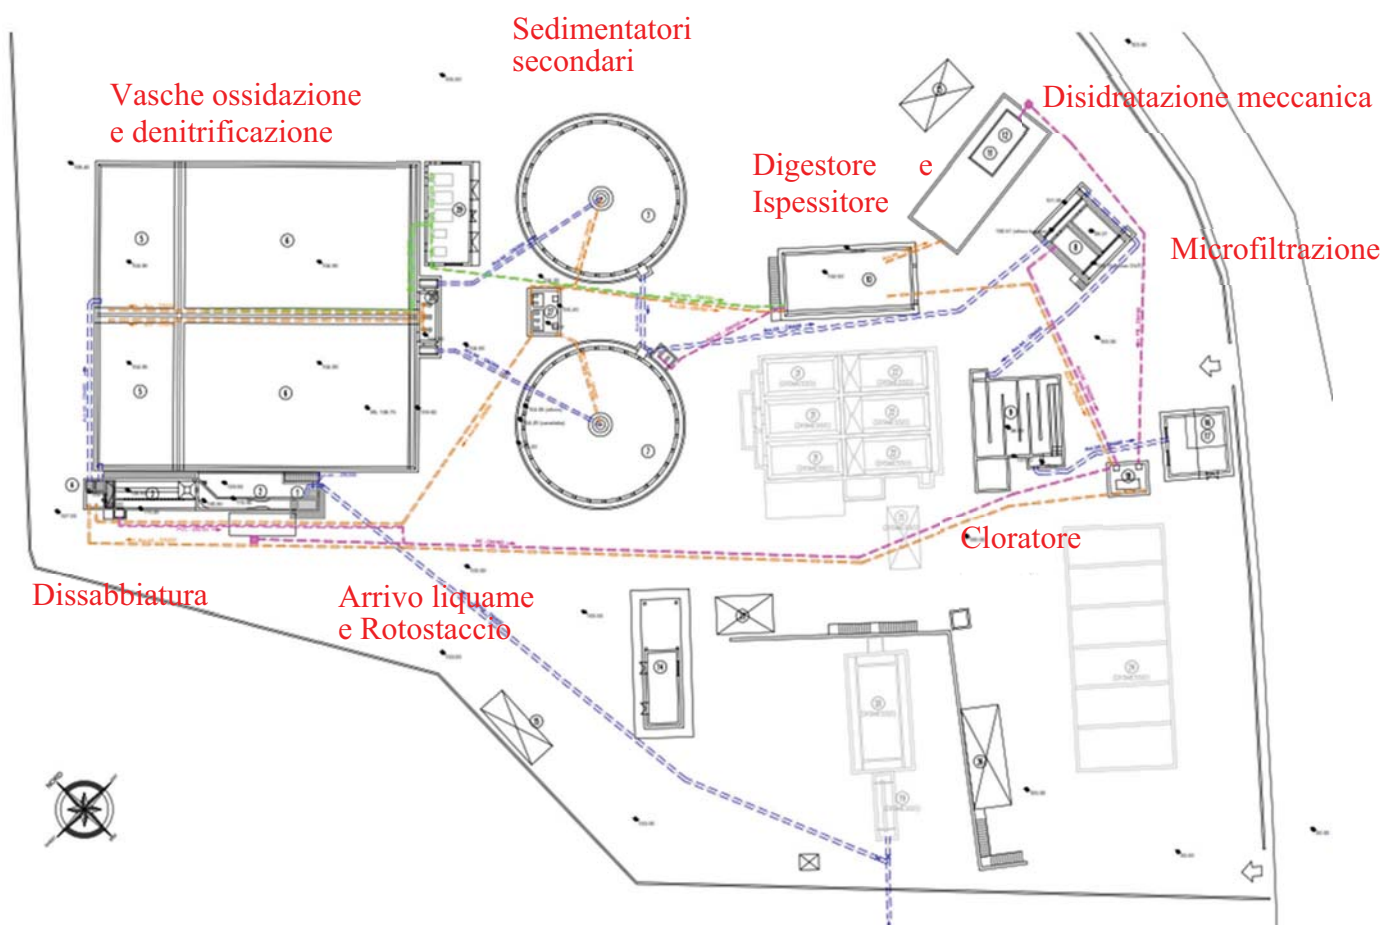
Planimetria dell'impianto nel suo stato attuale. rif. Elaborato 05 Planimetria ante operam)
